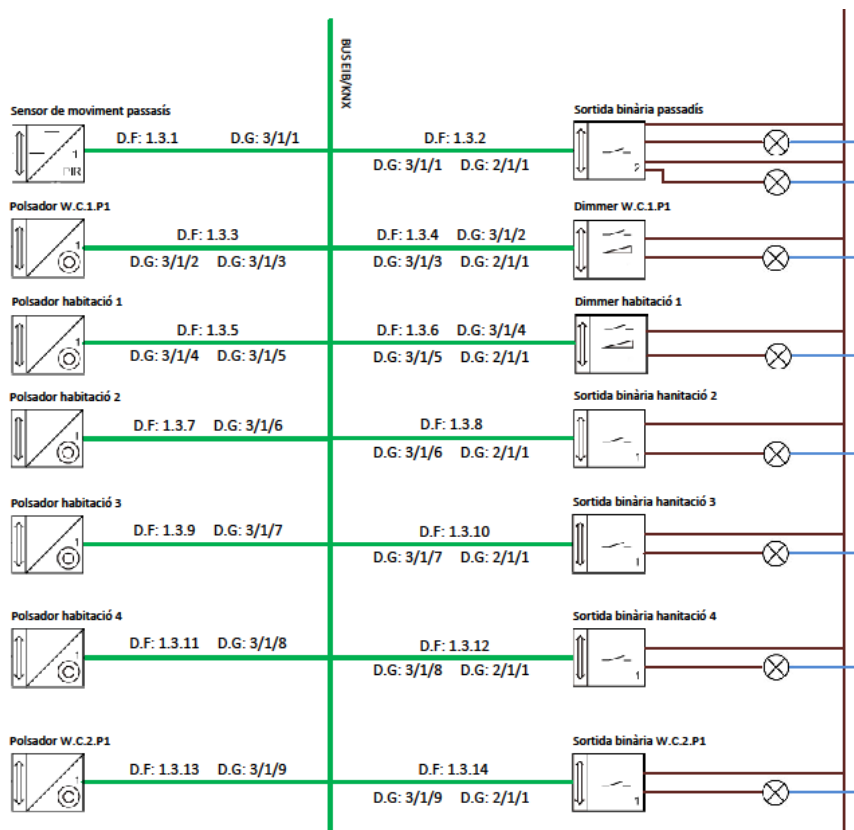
Esquema domòtic d' il·luminació primera planta
